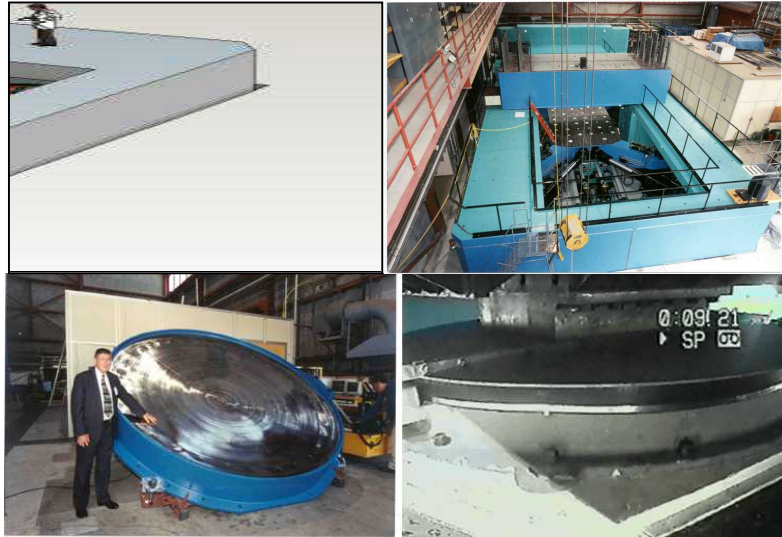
일체형 UTM을 활용한 Rubber Bearing 성능시험
